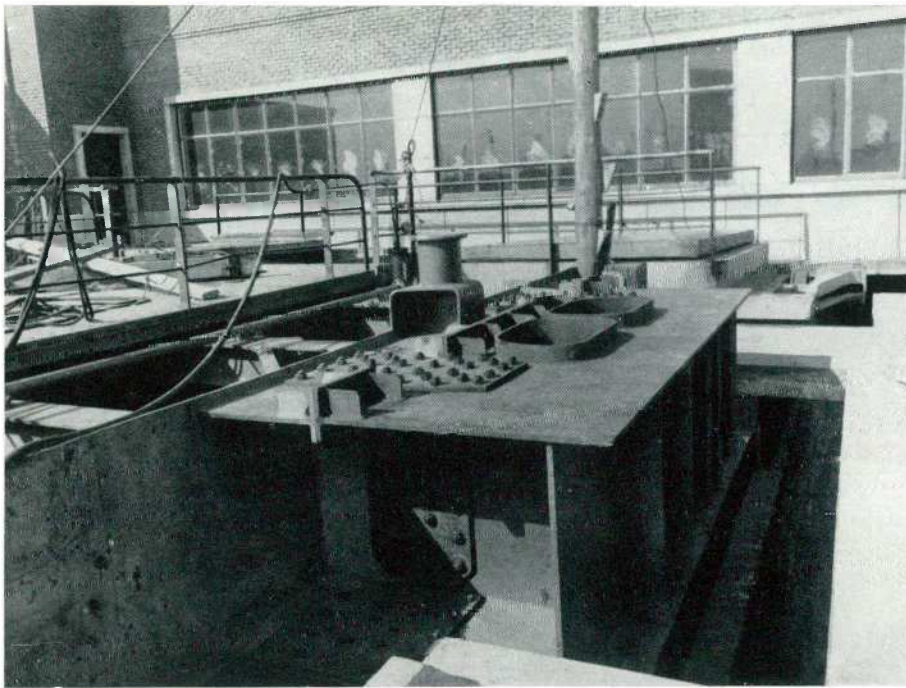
CONSOLE PROVISOIRE DE SUSPENSION DE PORTE.
